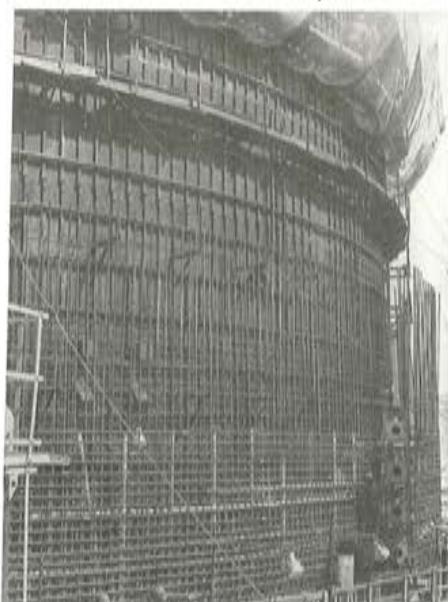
Detalle de la fotograffía anterior — Trmpetas de los tendones y puesta a tierra de las armaduras.
